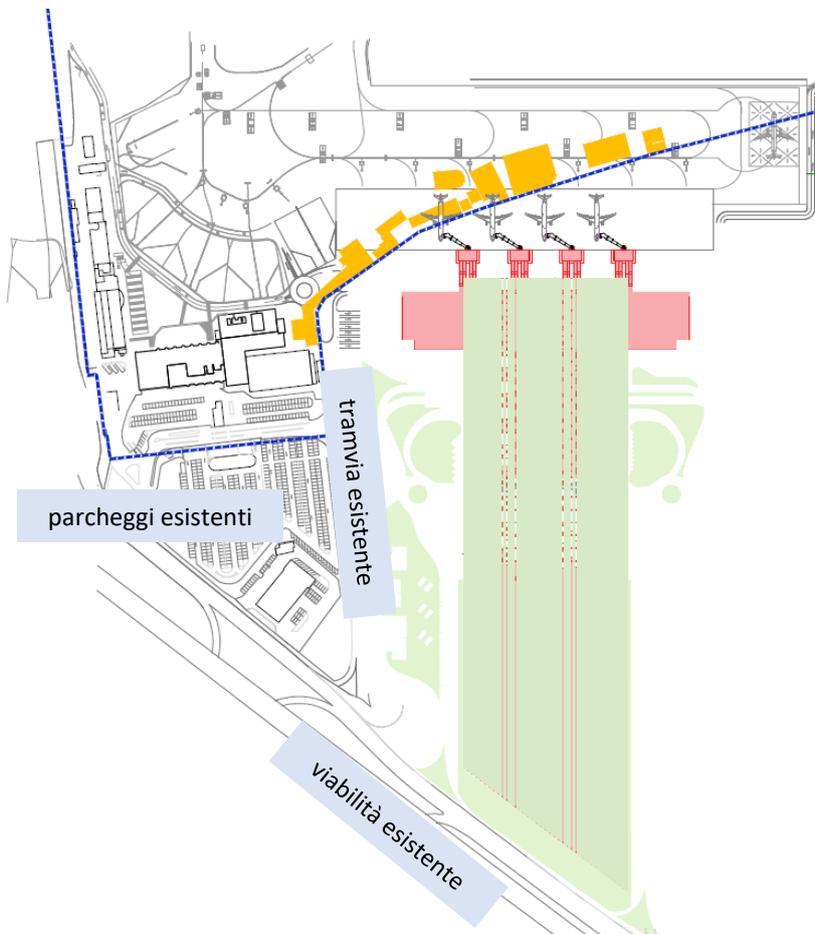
Planimetria confronto stato di fatto - progetto, con identificazione delle aree verdi edificate
